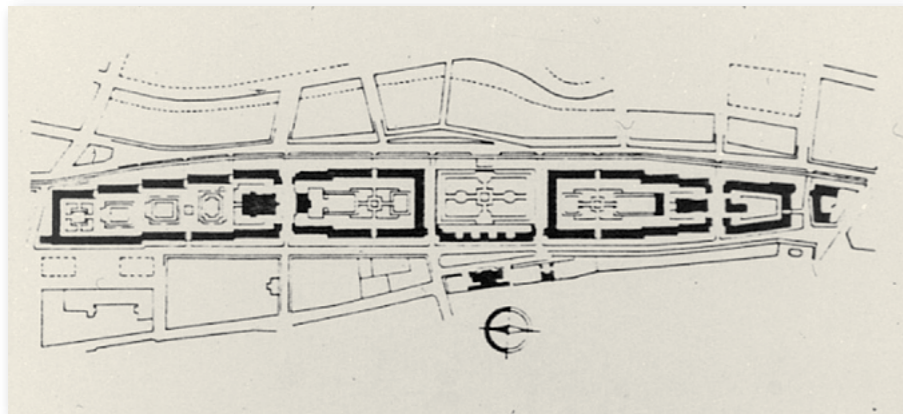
Karl Marx Hofe, planta y vista exterior Ehn (1927-1930)
